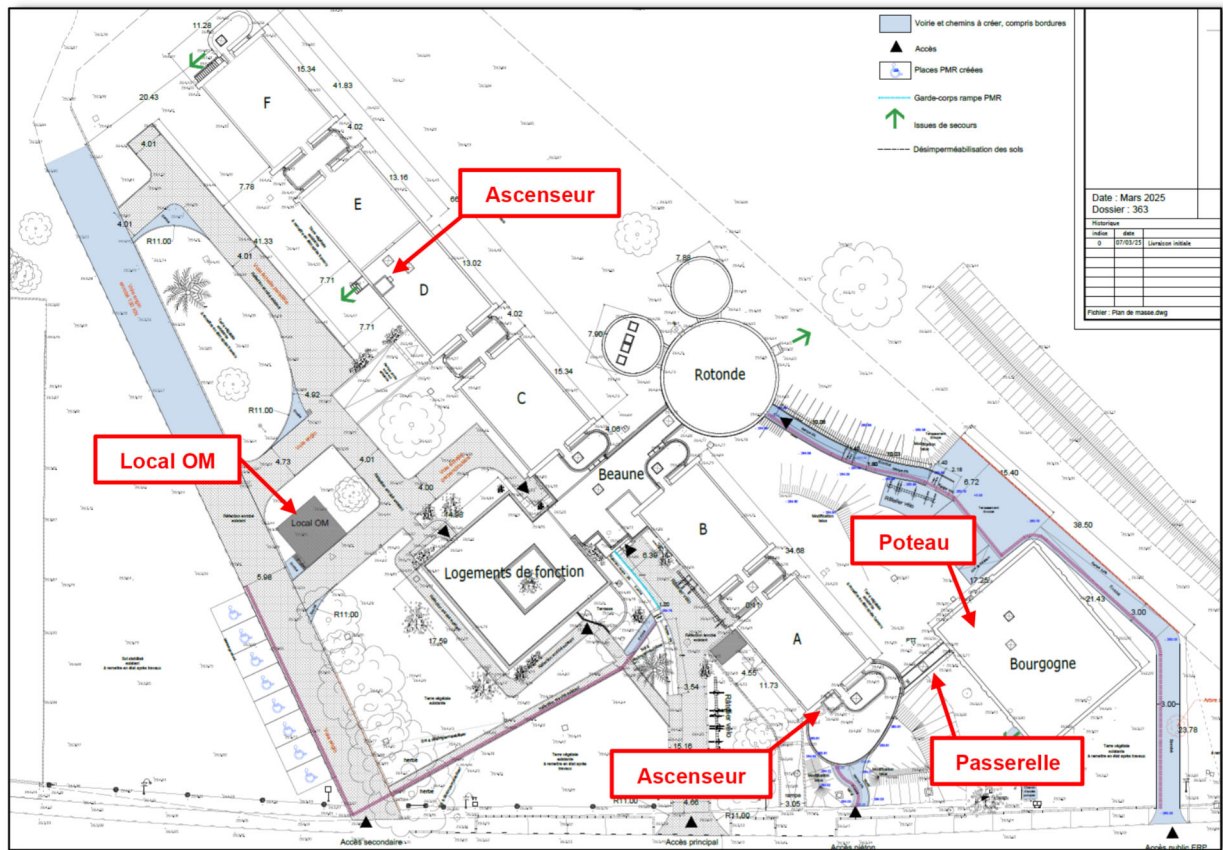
Plan de masse du projet – Source : cabinet A & B architectes (7/3/2025)
